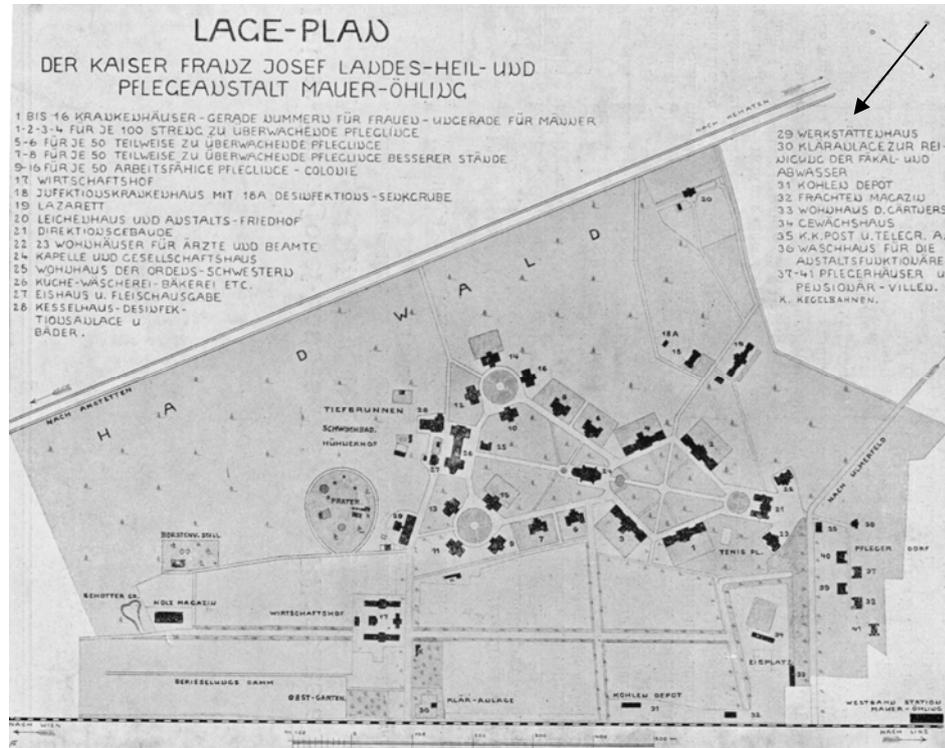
LAGEPLAN MAUER-ÖHLING 1898
